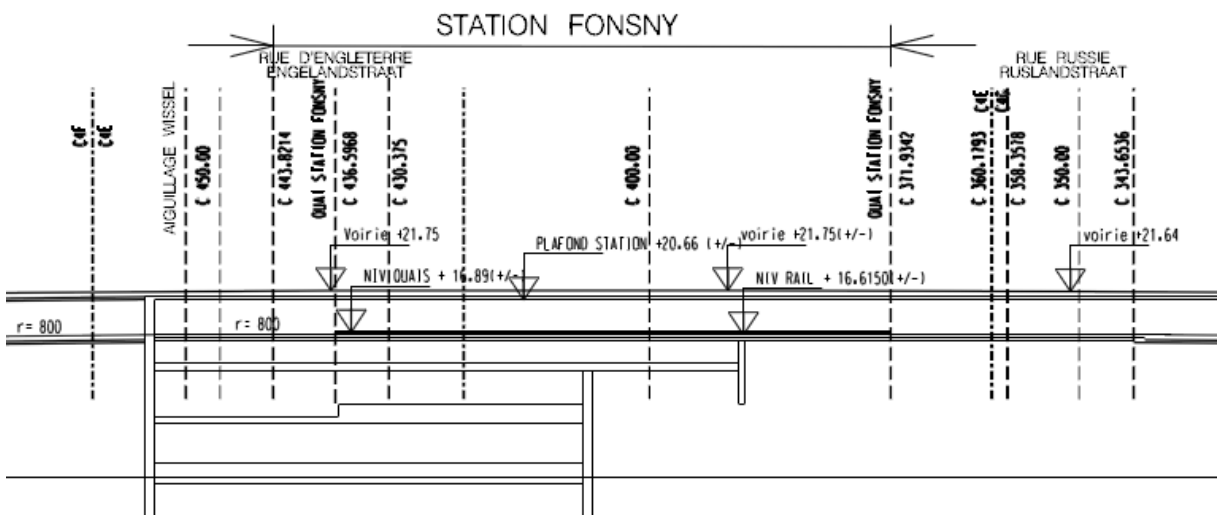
Coupe – situation de la station tram Gare du Midi
